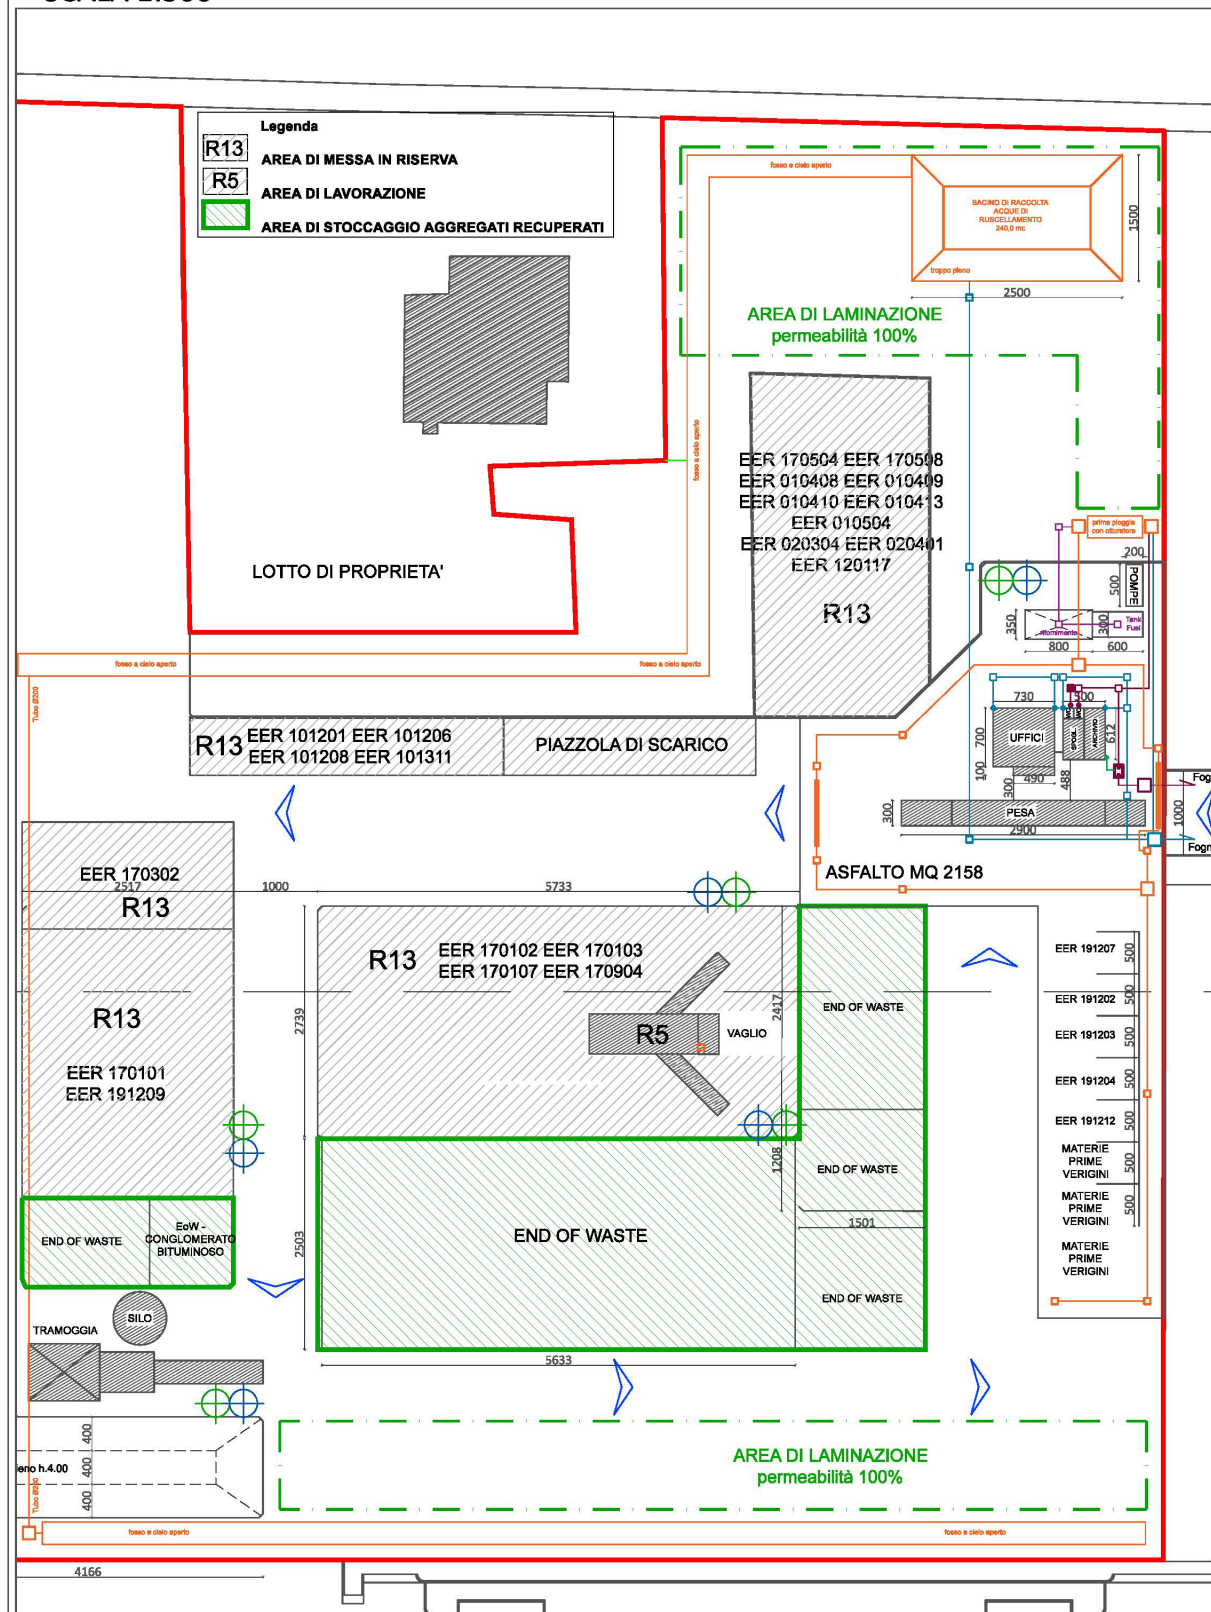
layout impianto (la linea rossa indica il limite area intervento)
